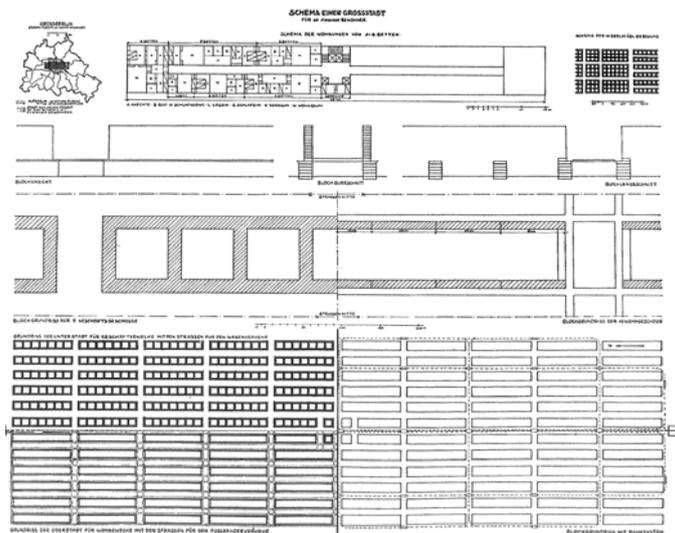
Schema einer Großwohnhochhausstadt nach Hilberseimer
